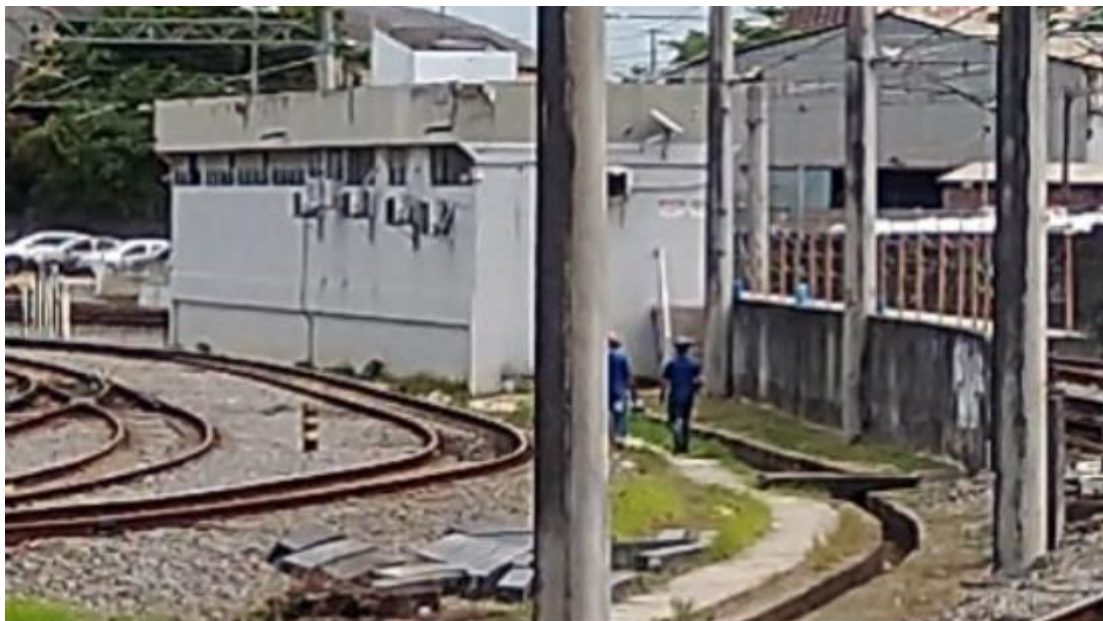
Fachadas norte e leste do Posto de Movimento de Cajueiro Seco
